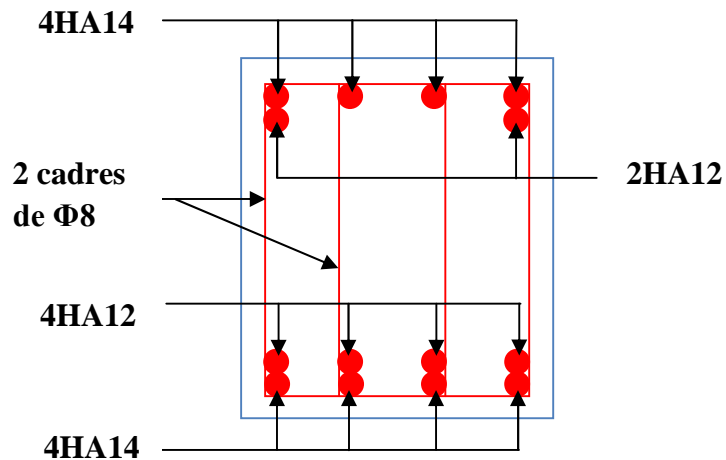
Schéma de ferrailage de la poutre brisée.
